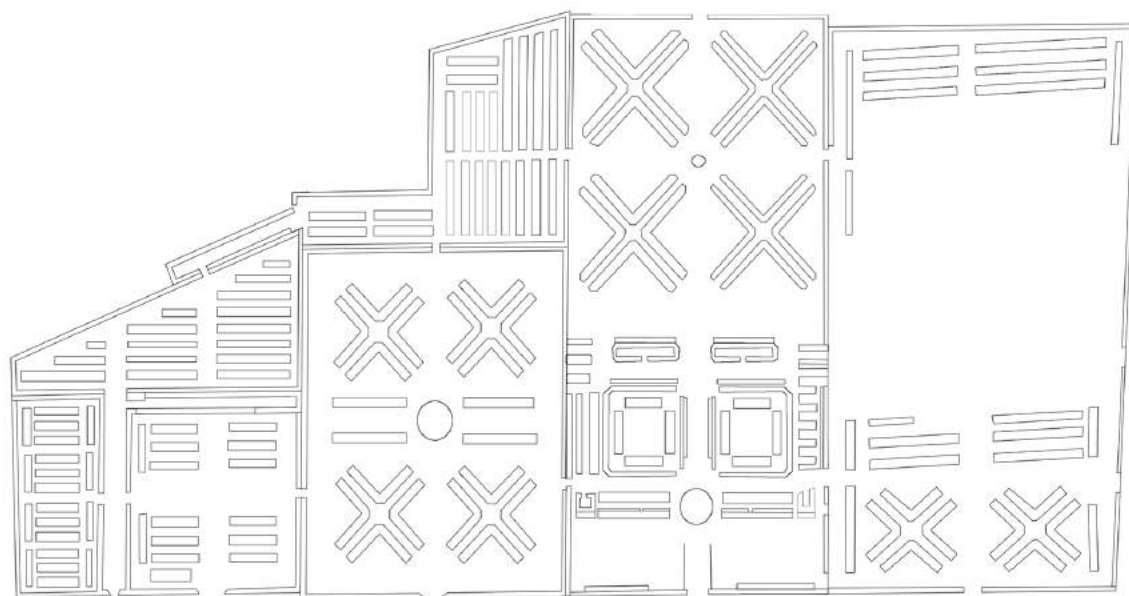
Plano del cementerio en 1939 elaborado en base a diversas imágenes. Fuente: Casalino Sen, 2014, p. 373-377.
